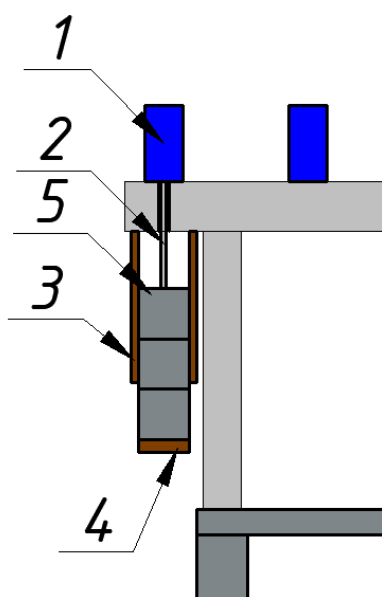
Опускание горизонтальной палубы с несколькими слоями бетона.
